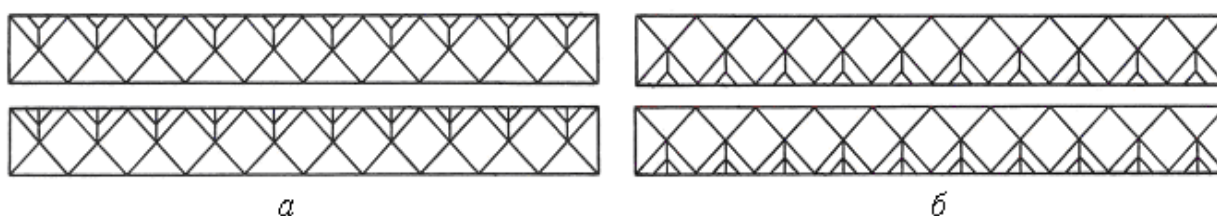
Схемы перекрестных решеток ферм с грузовыми верхними поясами и Y-, Ψ-образными полустойками (а), а также с грузовыми нижними поясами и Y-, Ψ-образными полуподвесками (б)
